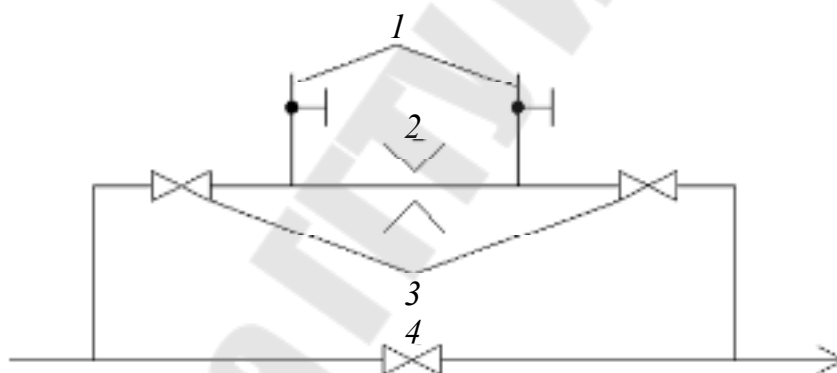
Схема байпаса для установки дроссельной диафрагмы на трубопроводе тепловой сети:
